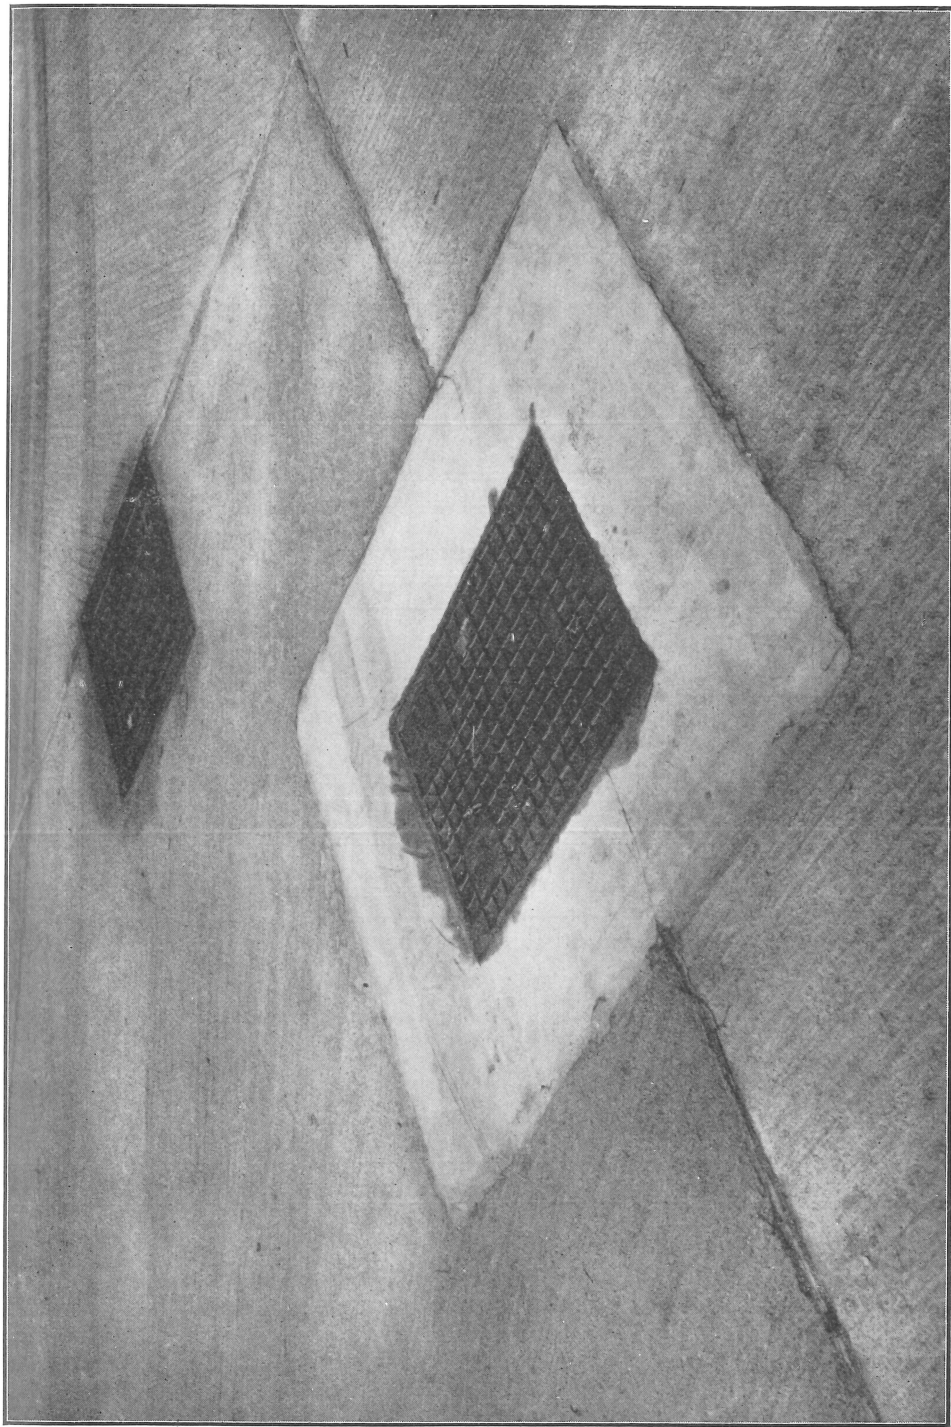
Jonctions complexes de dalles bétonnées et de taques. (Remarquer l'absence de fissures dans le béton des dalles et l'existence d'une fissure dans le béton ordinaire entourant la grande taque, fissure située dans l'alignement du joint longitudinal de la route en béton.)
